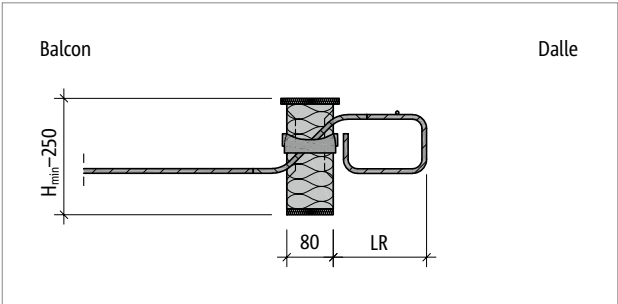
Schöck Isokorb® Type Q-E-W : Coupe du produit, affichage de la longueur d’installation LR
